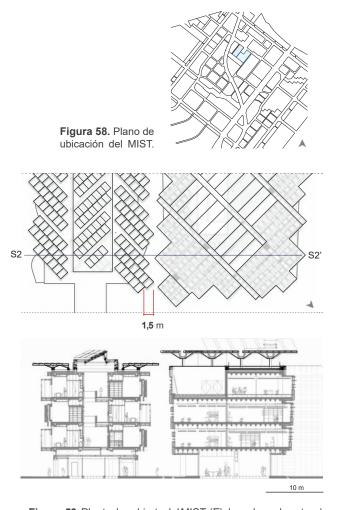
Planta de cubierta del MIST. (Elaborado por la autora) Figura 60. Sección S2-S2' del MIST. (Editado por la autora a partir de Nigel Young/Foster + Partners).
